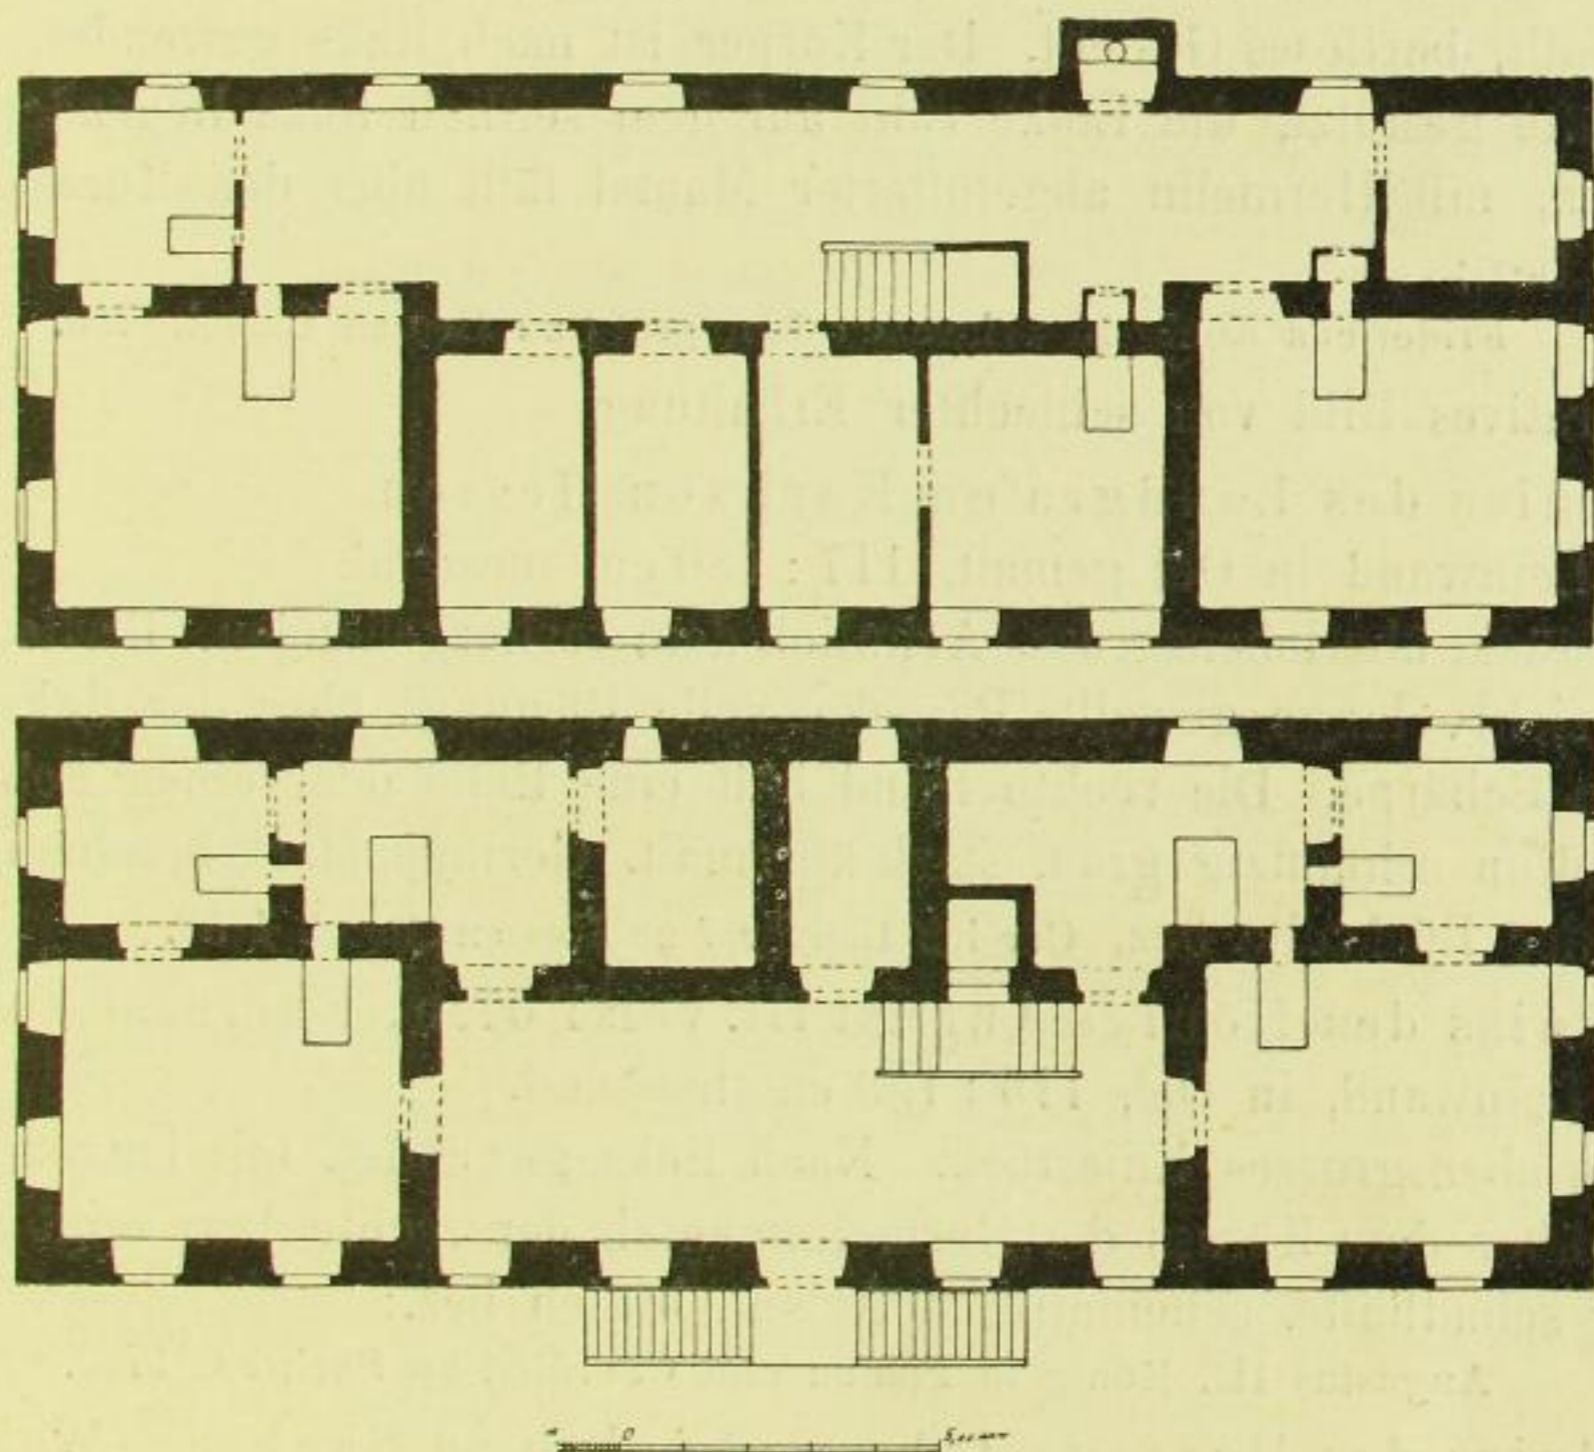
Döhlen, Pfarrhaus, Grundriss des Erd- und ersten Obergeschosses.
